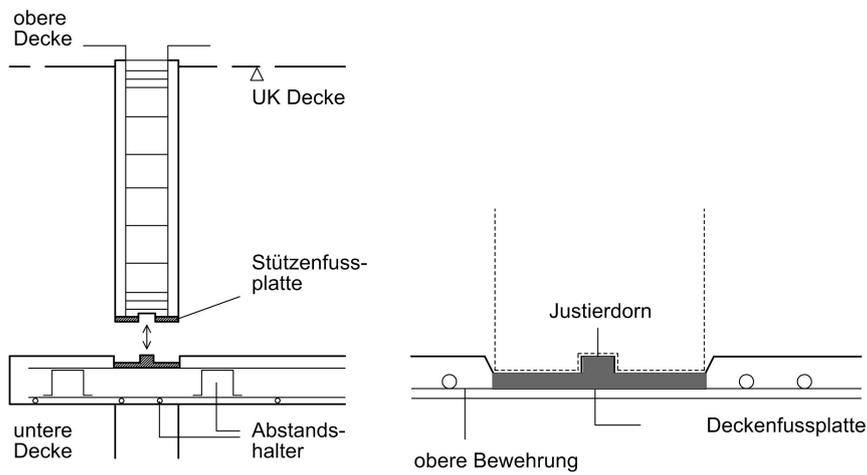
Einbau einer Fertigteilstütze im Hochbau
